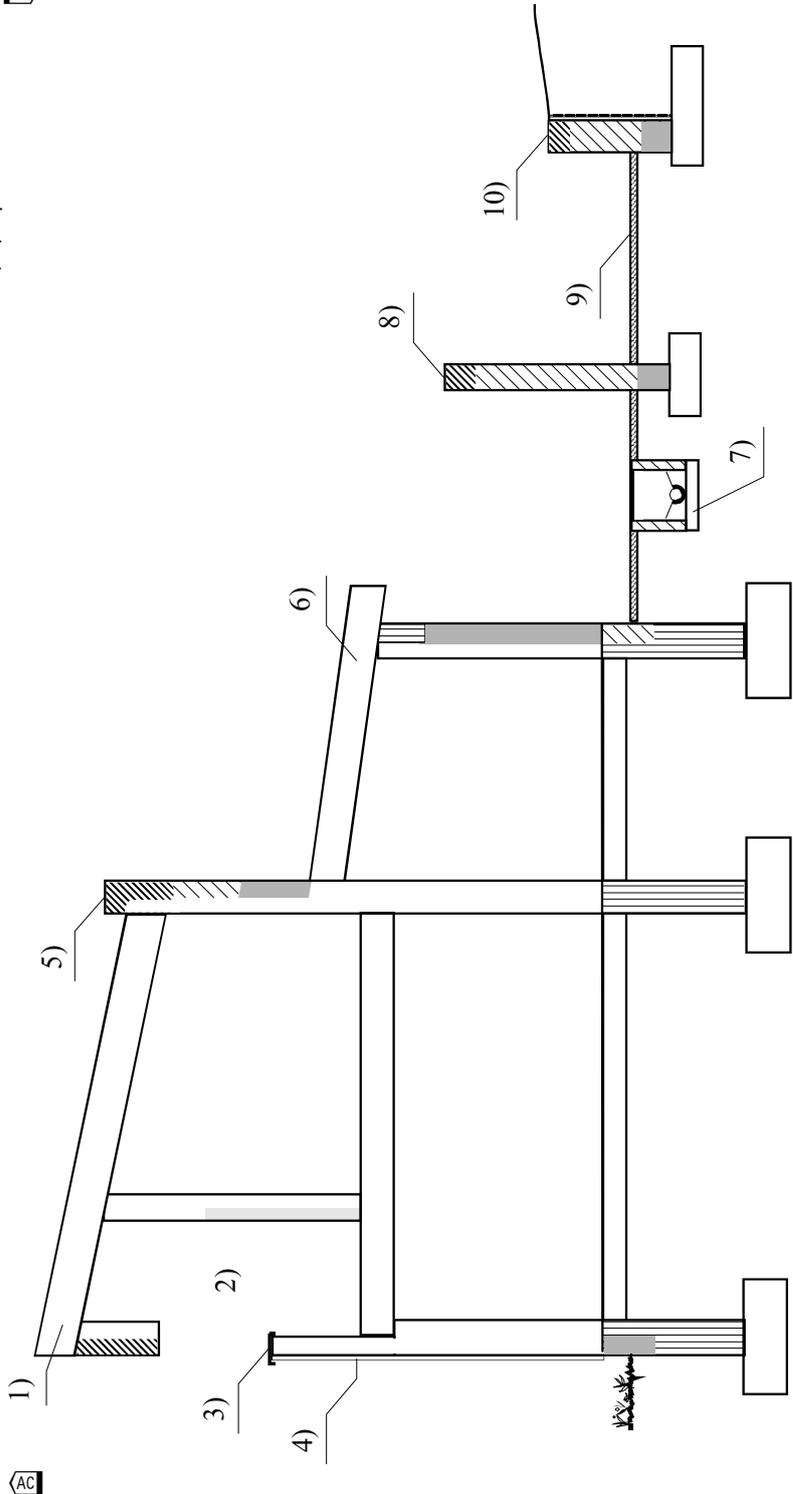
Beispiele für die vergleichbaren Expositionen des Mauerwerks bezüglich der Feuchtebeanspruchung (Mauerwerk, das nicht durch Oberflächenbehandlungen oder Bekleidungen geschützt ist, oder Mauerwerksgründungen in gut entwässernden Böden)
